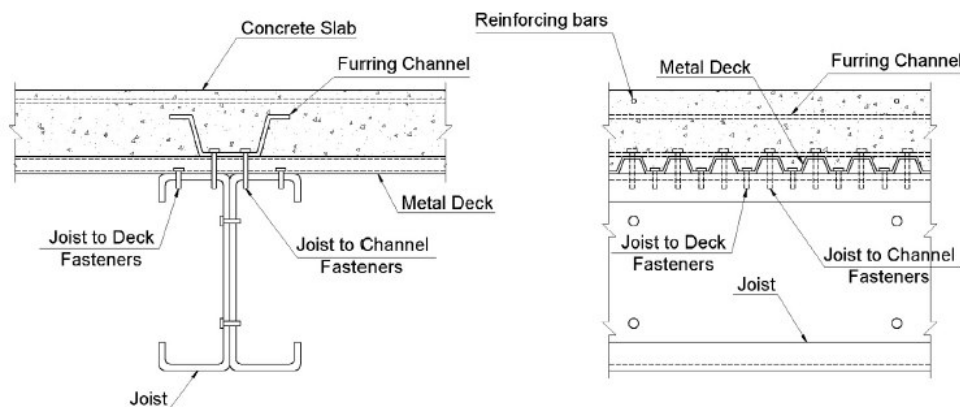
Solução mista com conectores de formato trapezoidal (vista de corte e vista lateral).
